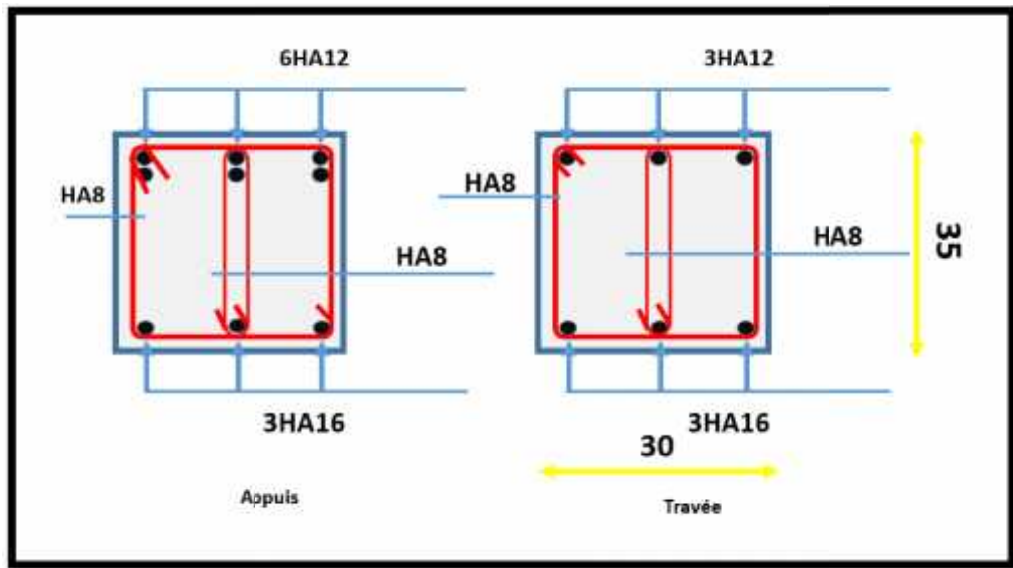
Schéma de ferrailage des poutres secondaires.(30x35)
